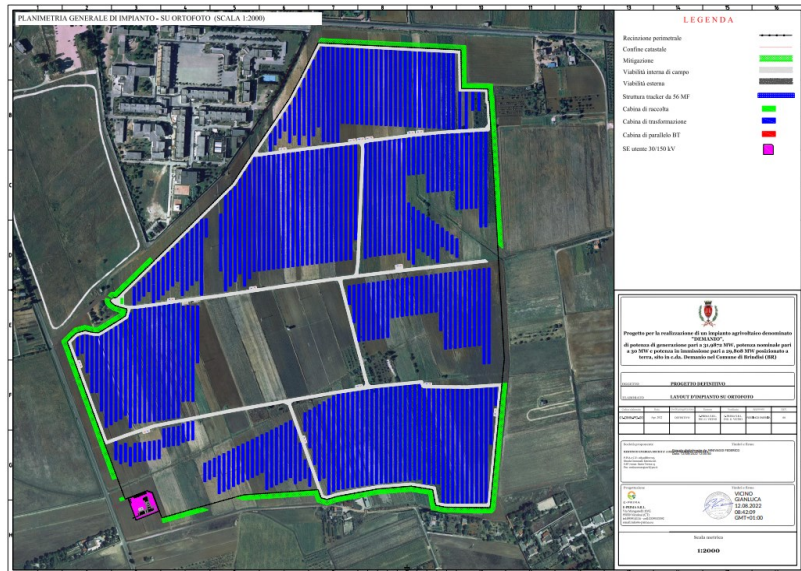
Particolare Layout su ortofoto cfr: 01-DMN-PD-00_LAYOUT_DI_IMPIANTO_SU_ORTOFOTO_signed
